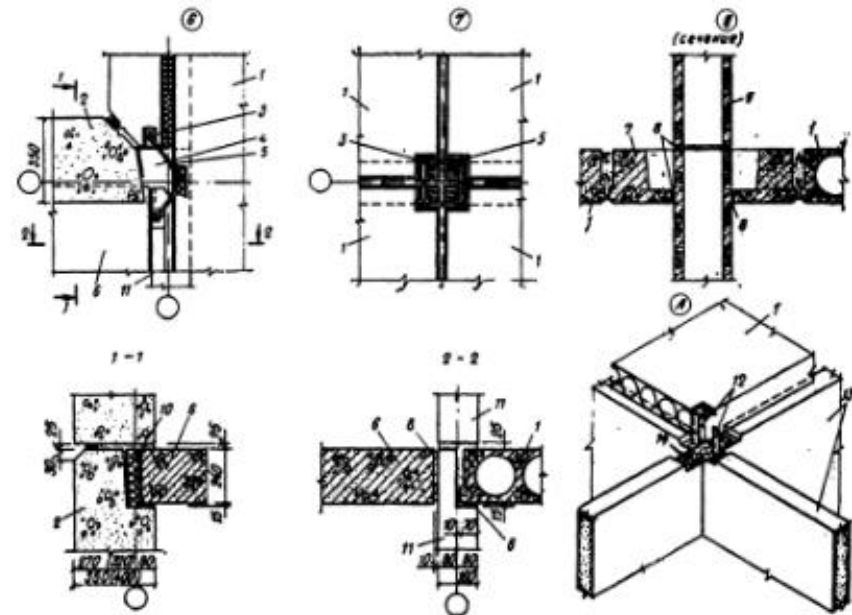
Узлы 6 — 8 сопряжения панелей перекрытия и узел А вертикальных межэтажных связей панелей внутренних стен: 1 — панель перекрытия; 2 — панель наружной стены; 3 — стальная закладная деталь; 4 — бетон замоноличивания; 5 — соединительный стержень; 6 — полуплощадка лестничного марша; 7 — сантехническая панель перекрытия; 8 — цементный раствор; 9 — вентиляционный блок; 10 — утепляющий вкладыш; 11 — панель внутренней стены лестничной клетки; 12 — межэтажные связи панелей внутренних стен; 13 — панель внутренней стены; 14 — поэтажные связи панелей внутренних стен
